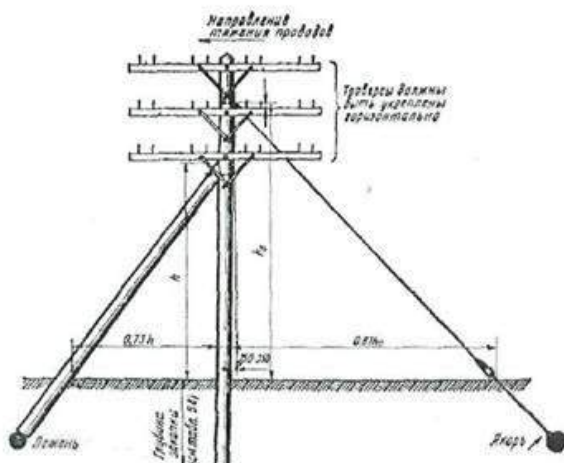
Угловая опора, укрепленная подпорой и оттяжкой.
